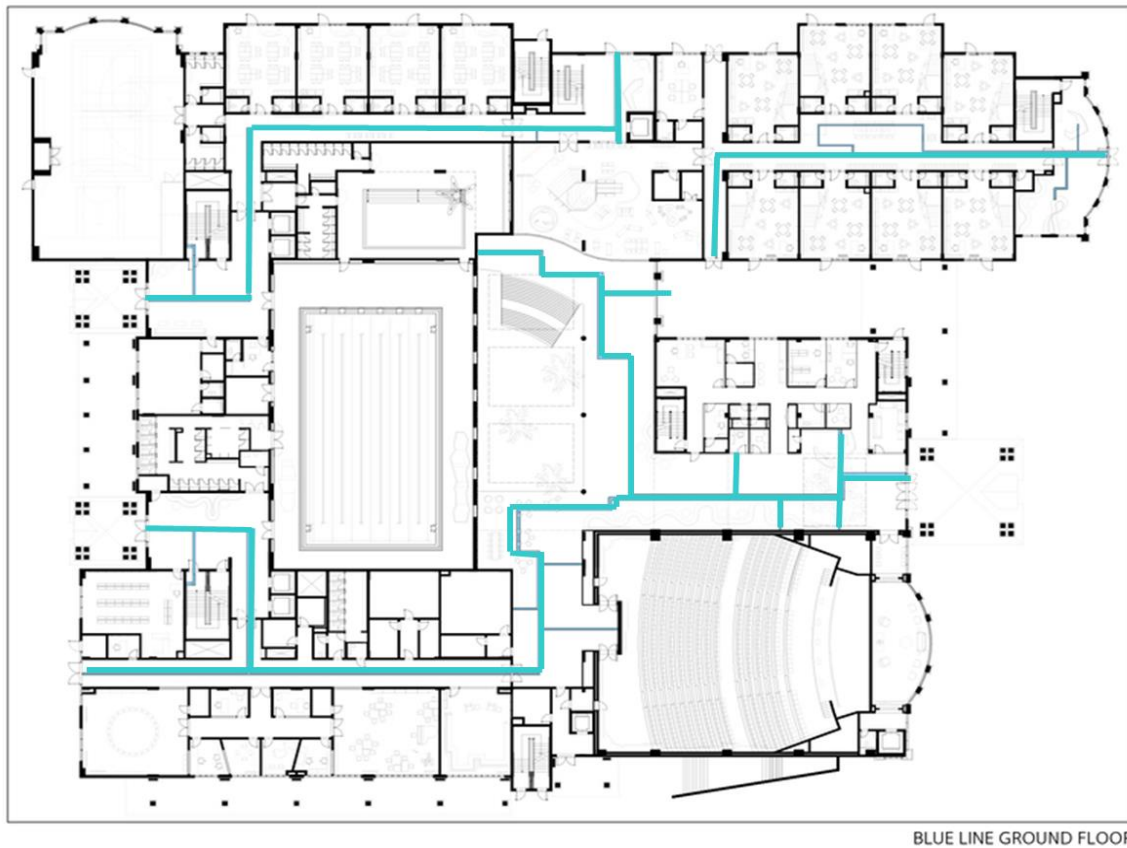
Estructura línea azul planta baja Academia Sheikh Zayed
